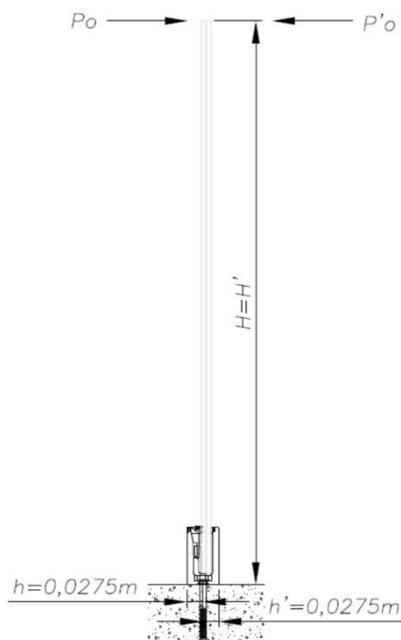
Dimensionnement des chevilles de fixation montage sur dalle
